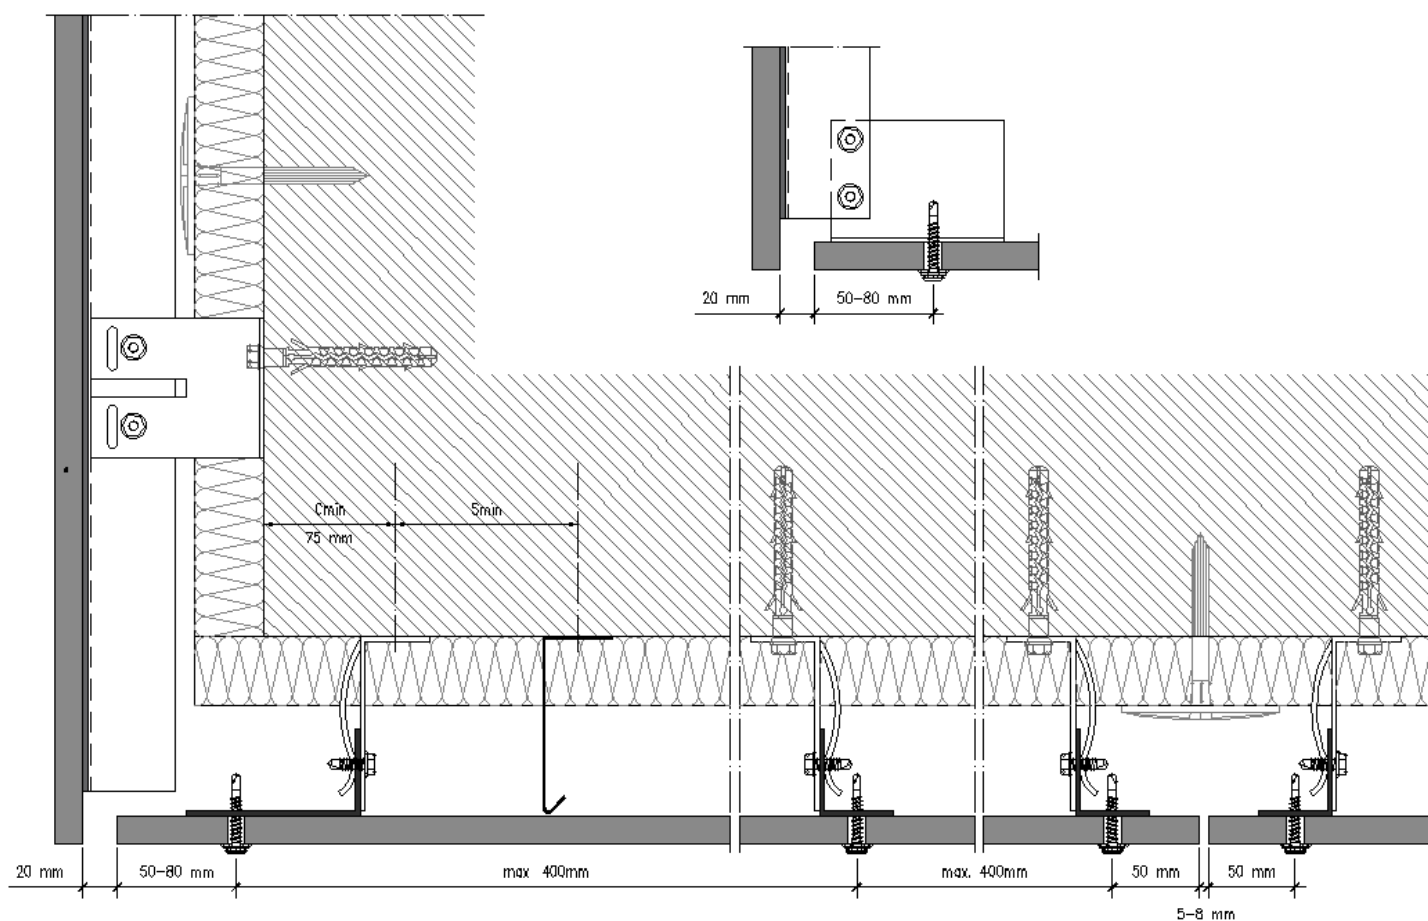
Pormenor da ligação Fachada - Teto falso
